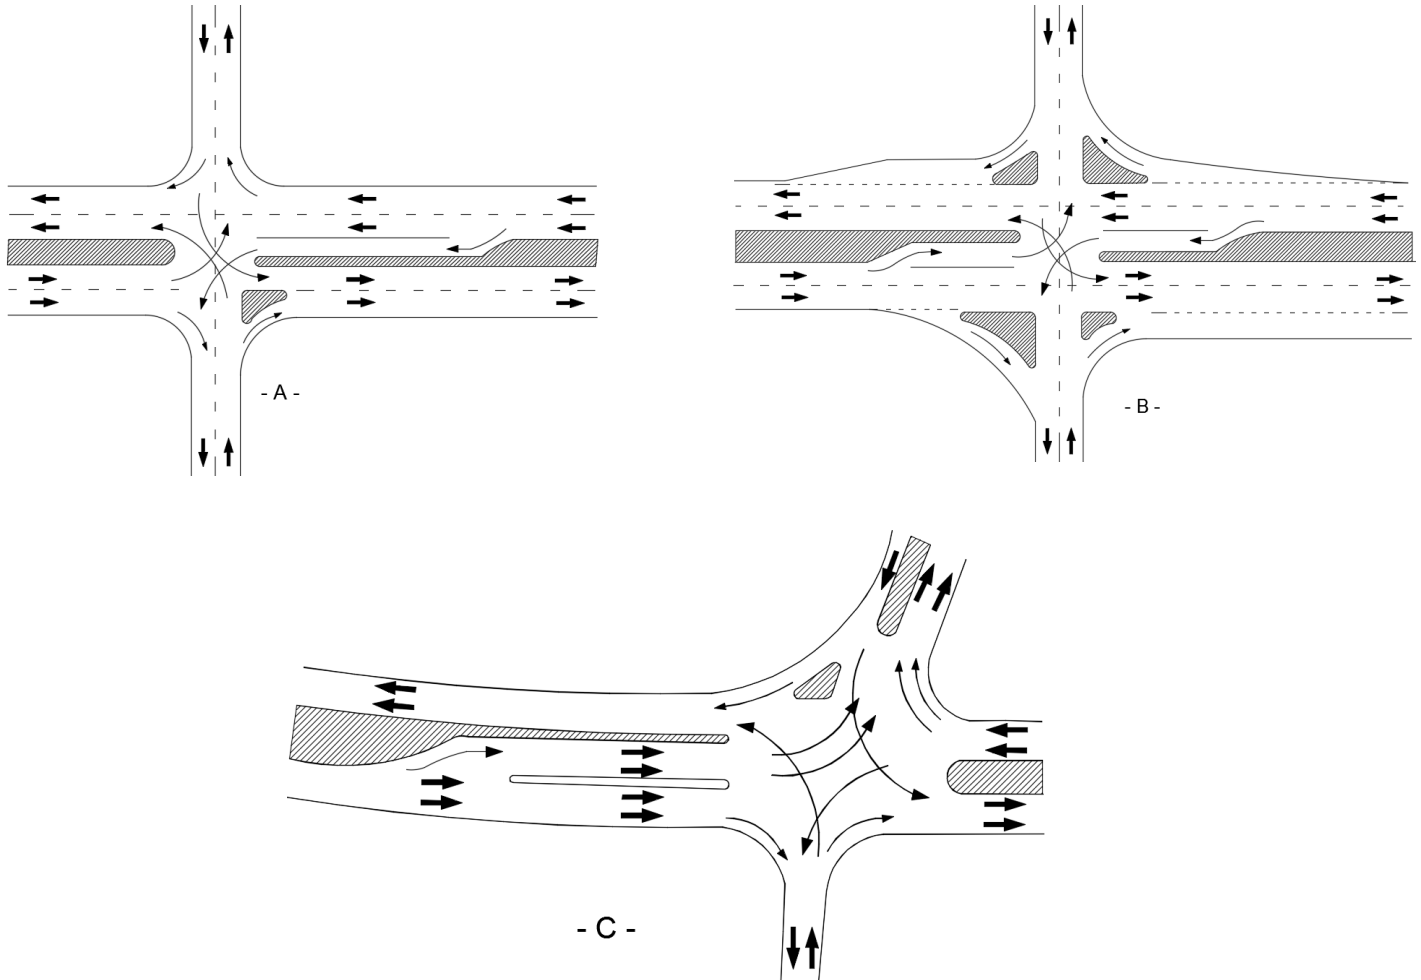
Intersecciones de cuatro ramas con alto grado de canalización
